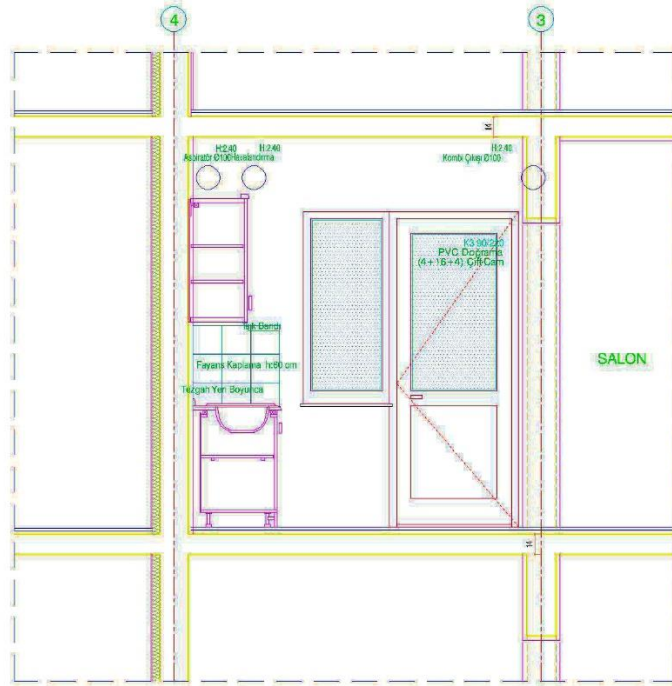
TOKİ 3+1 mutfak yerleşim planı
